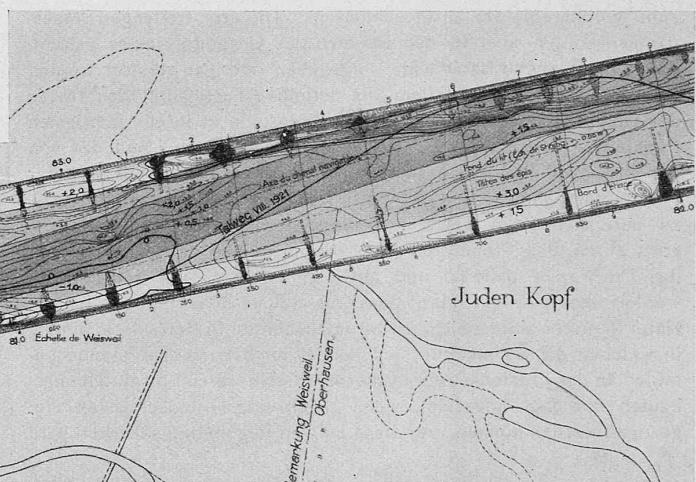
und 19. Grundriss 1:10000 und Längenprofil 1:10000/1:200 von bad. Km. 80 bis 82, in der Auflandungstrecke bei Weisweil-Schönaus.
